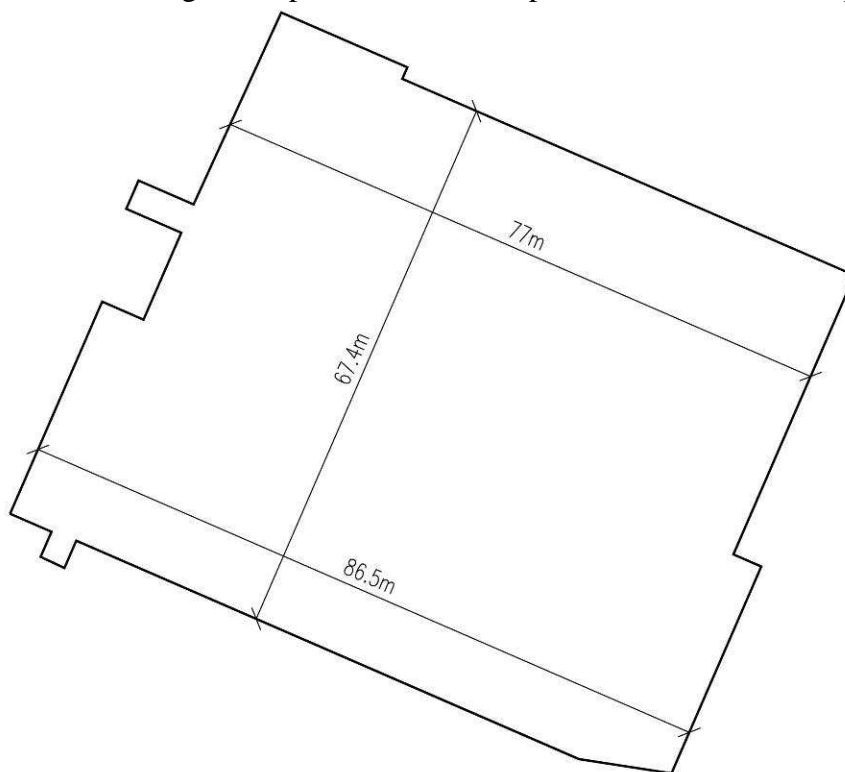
dimensioni di ingombro planimetrico della platea al di sotto del parcheggio.
